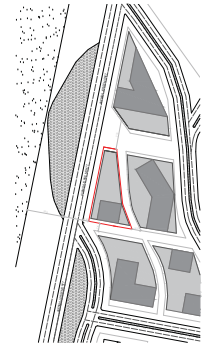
Esquema Maestría plan las Salinas con edificio desarrollado en el proyecto. Fuente: elaboración propia
